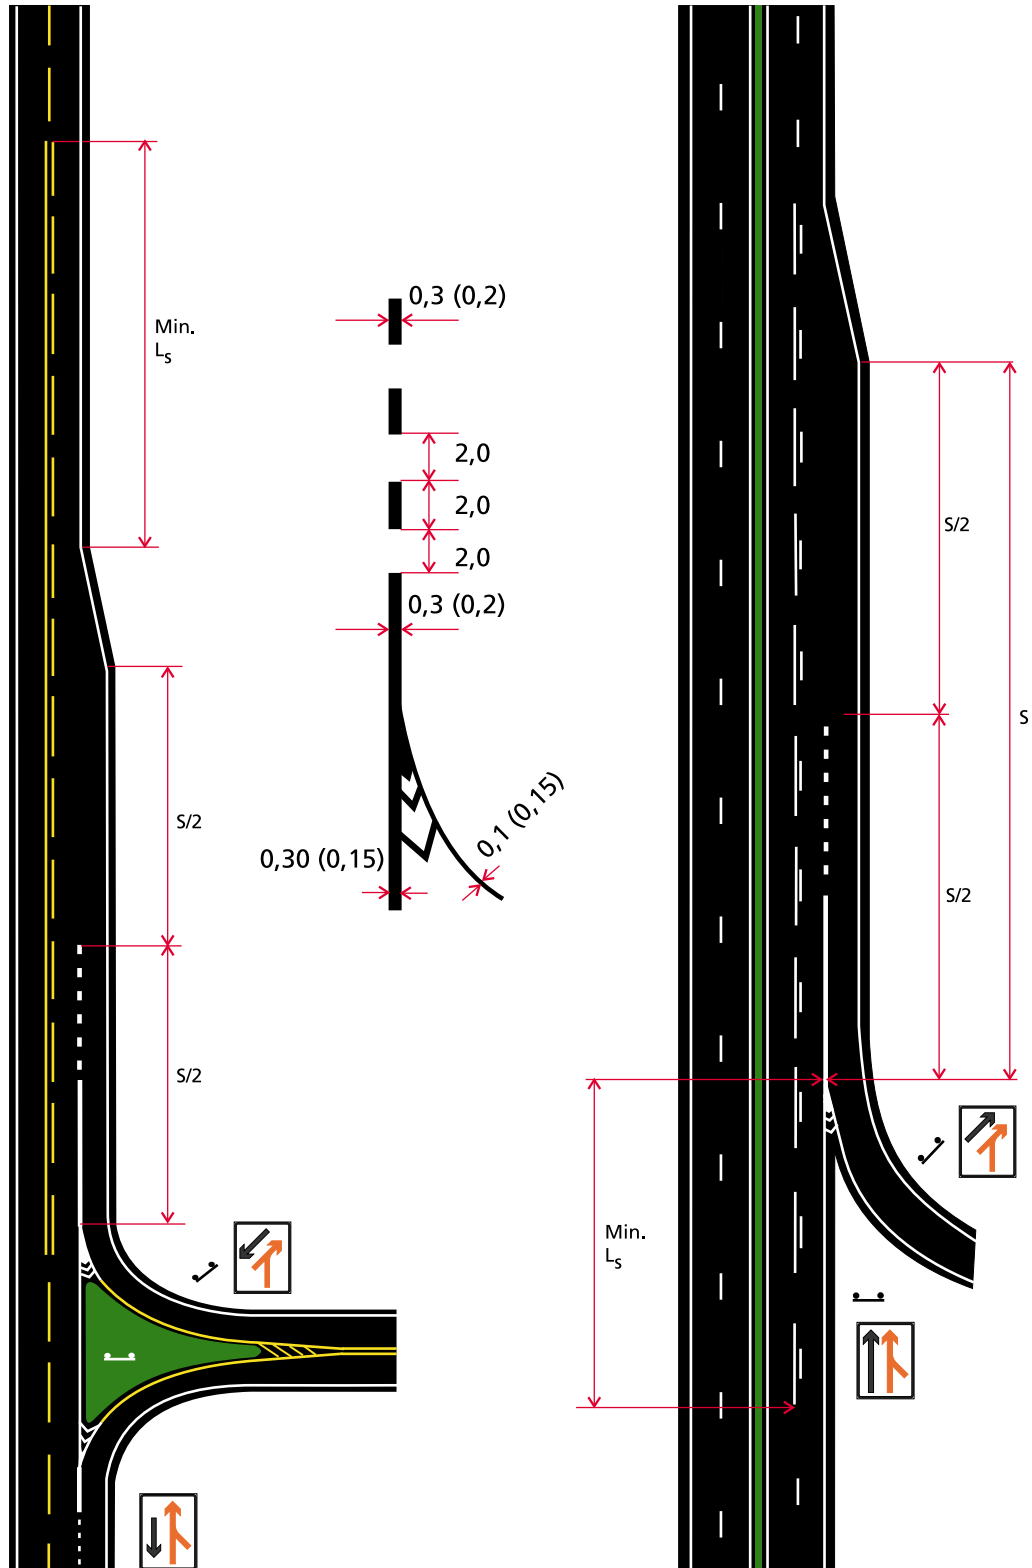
Planskilte kryss - langsgående oppmerking på primærvæg
